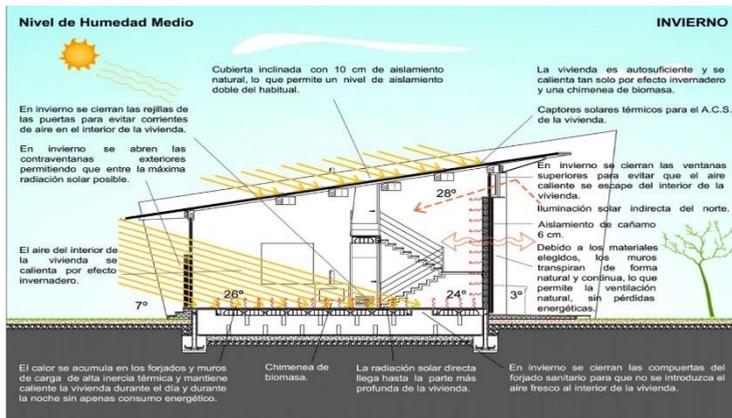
Fuente: L De Garrido. Esquema Ramat Eco-House. Año: 2011
